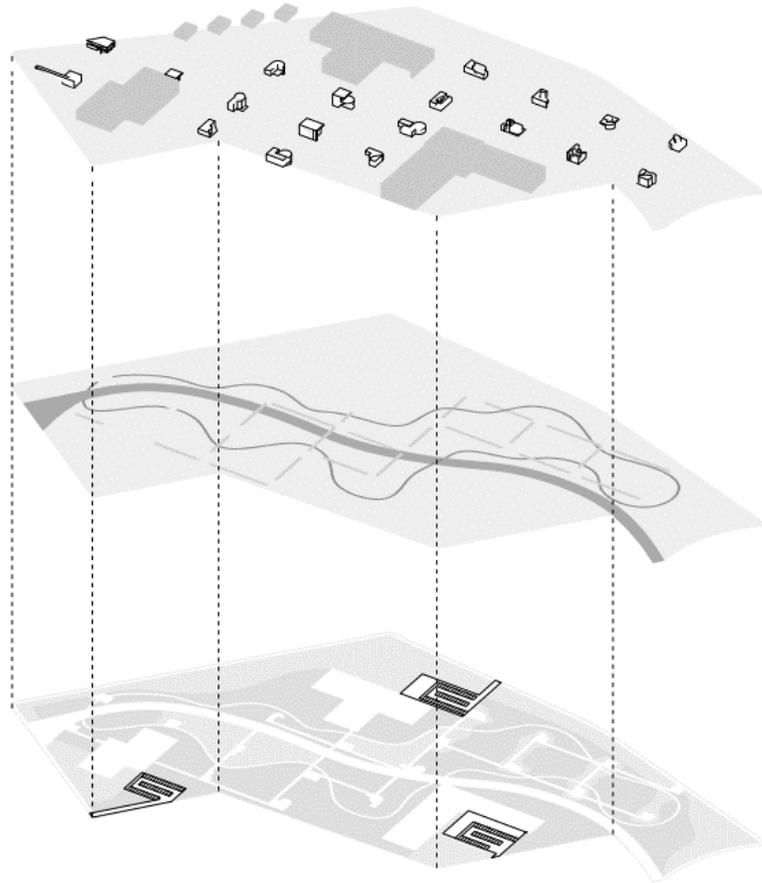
Axonometría capas plan maestro. Elaboración Taller 9
